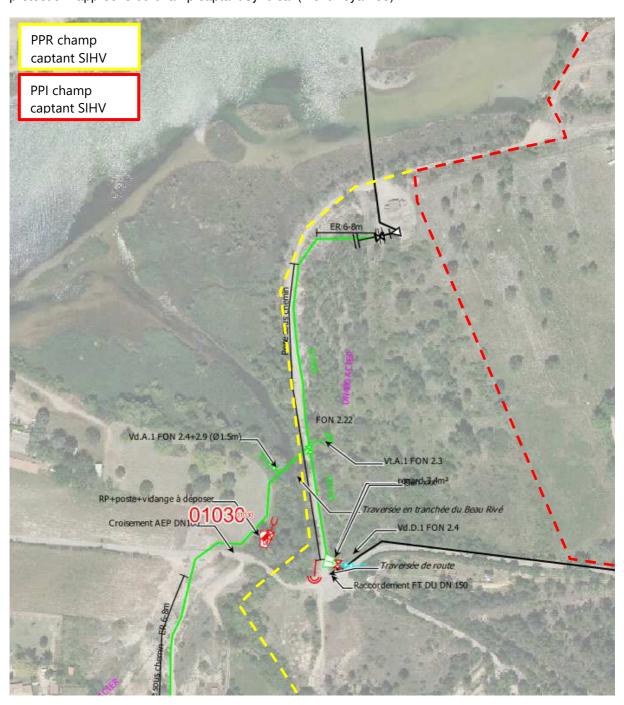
Zoom sur le tracé dans le PPR (fond Orthophoto®)
